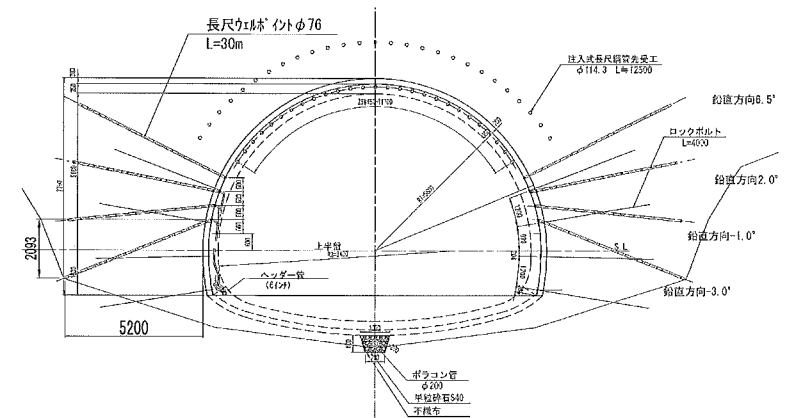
向山層(泥岩)の上昇に伴う坑内長尺WP施工図
